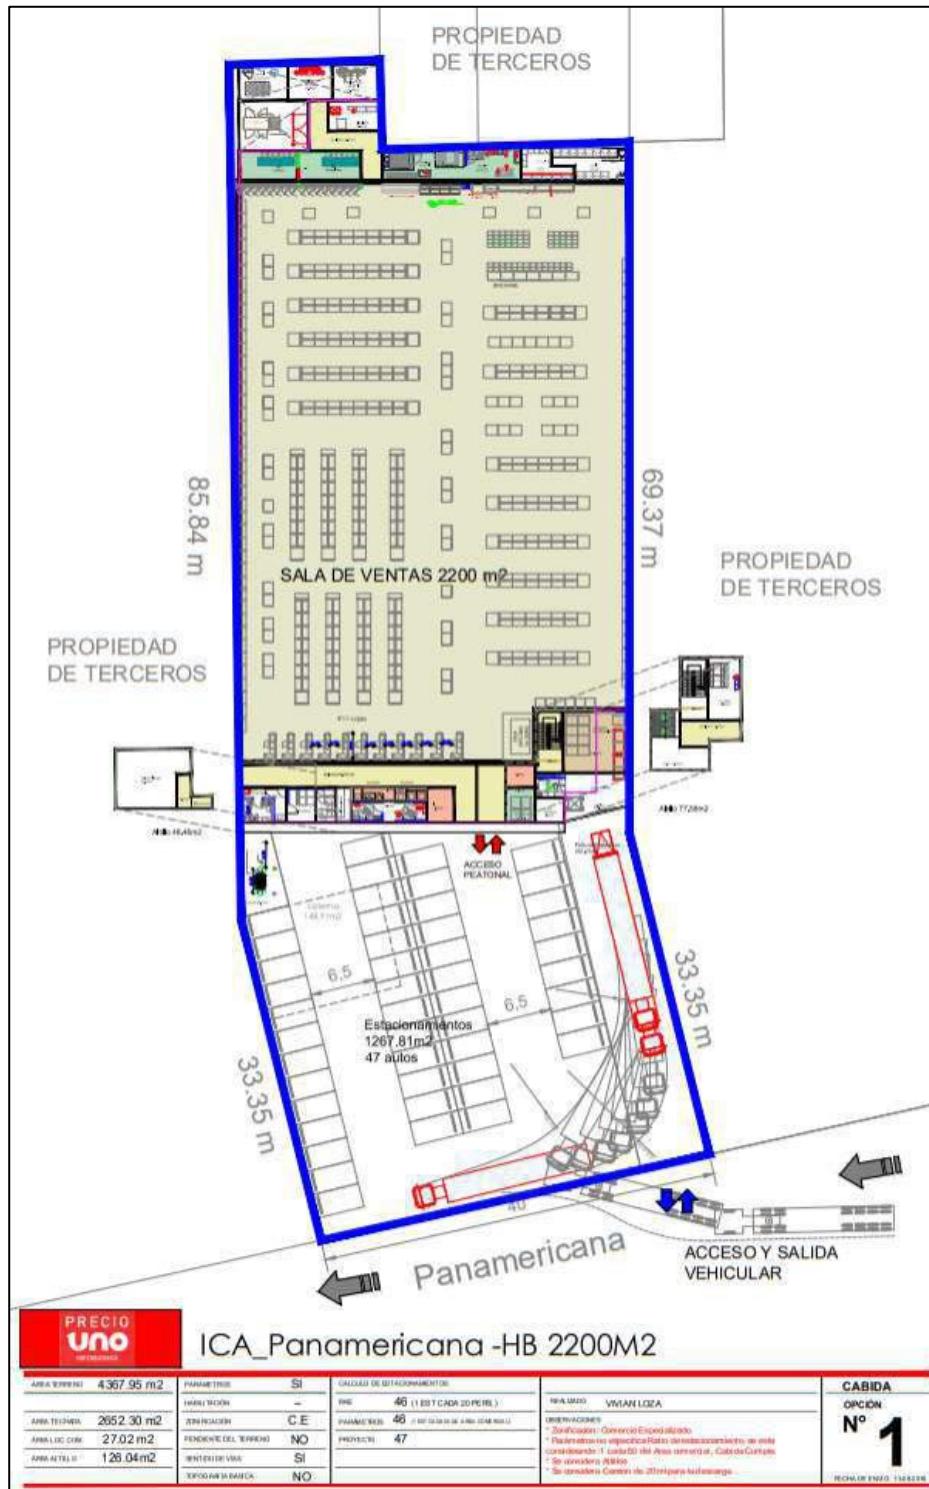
Plano de Cabida del Proyecto Ica Panamericana
